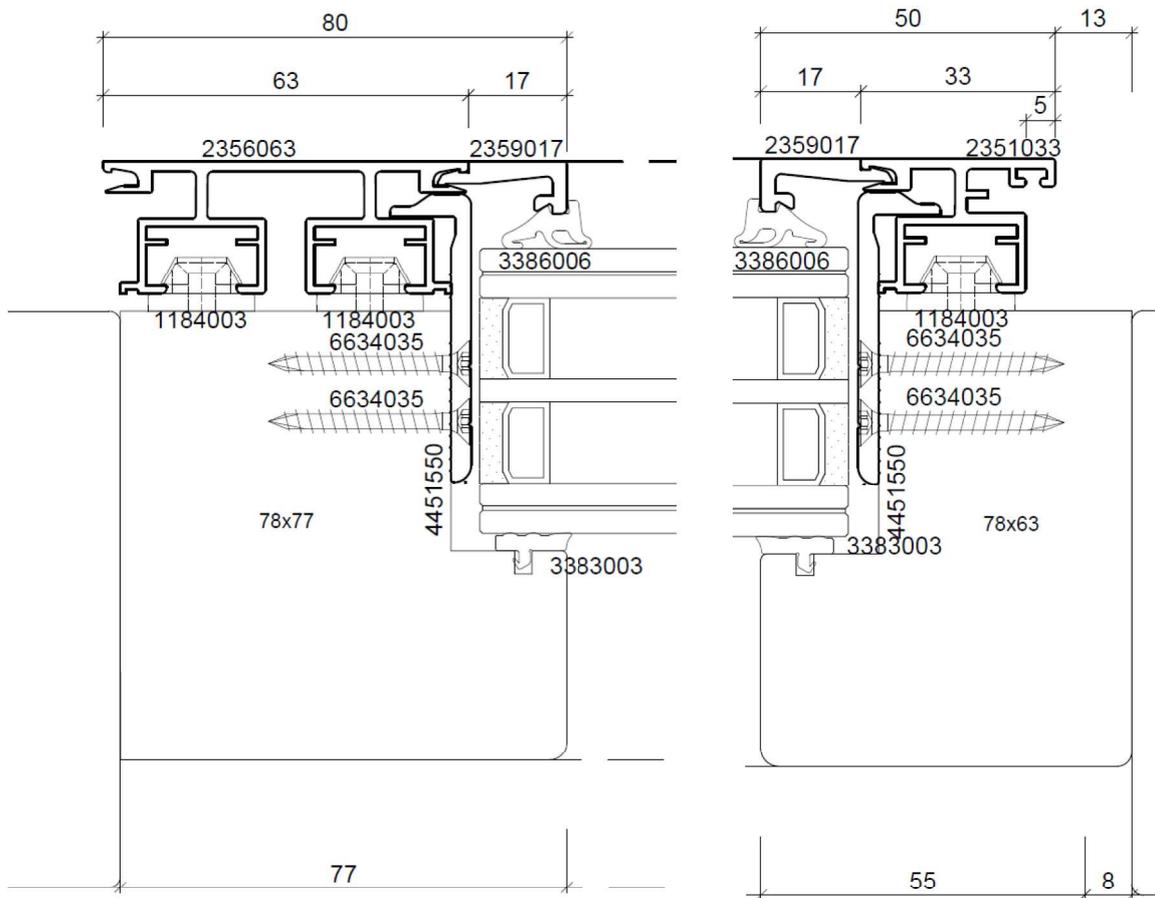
Querschnitt Glasaufleger (Links: Glasaufleger an Setzhölzern; Rechts: Glasaufleger an Blendrahmen)
